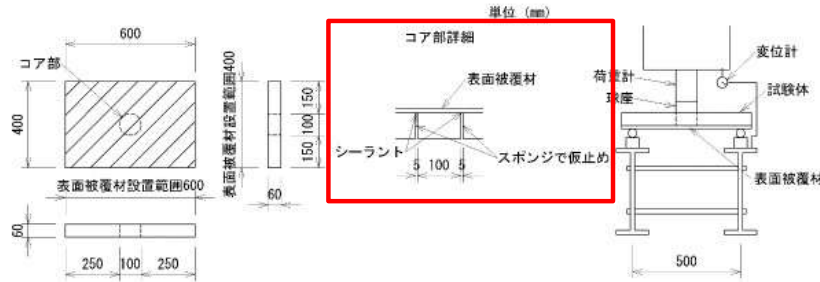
試験体の形状・寸法、試験方法の概要図
